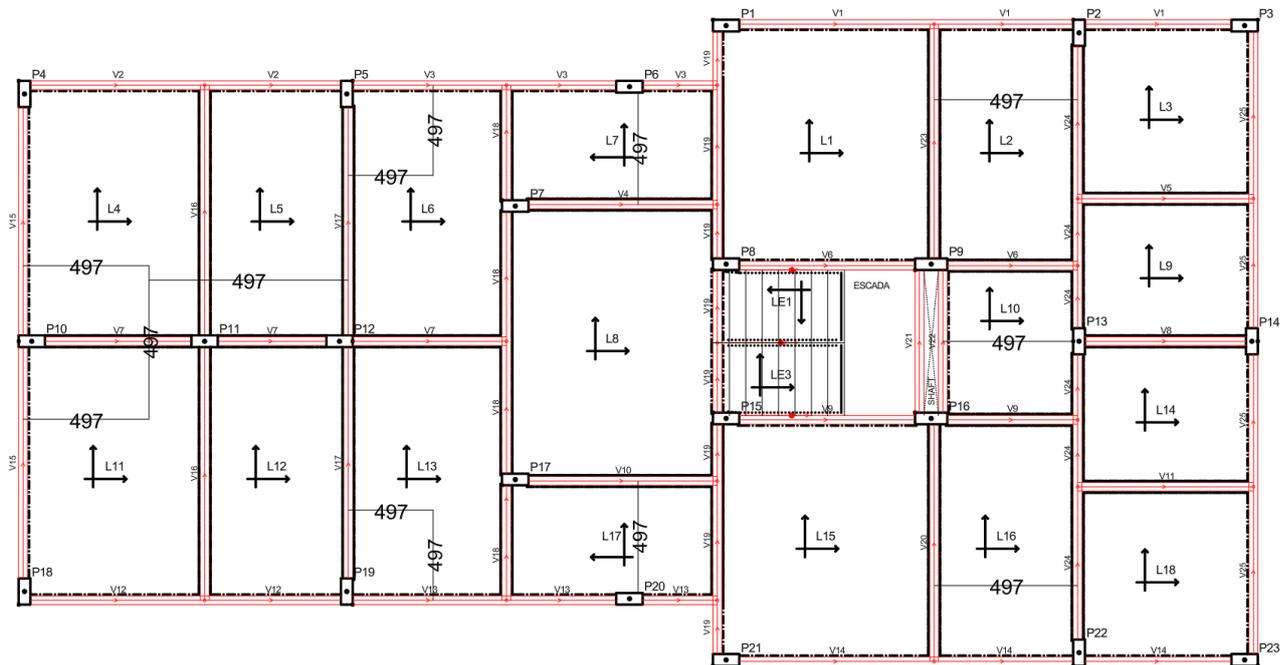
Concepção estrutural do Pavimento Tipo a partir do pré-dimensionamento.
